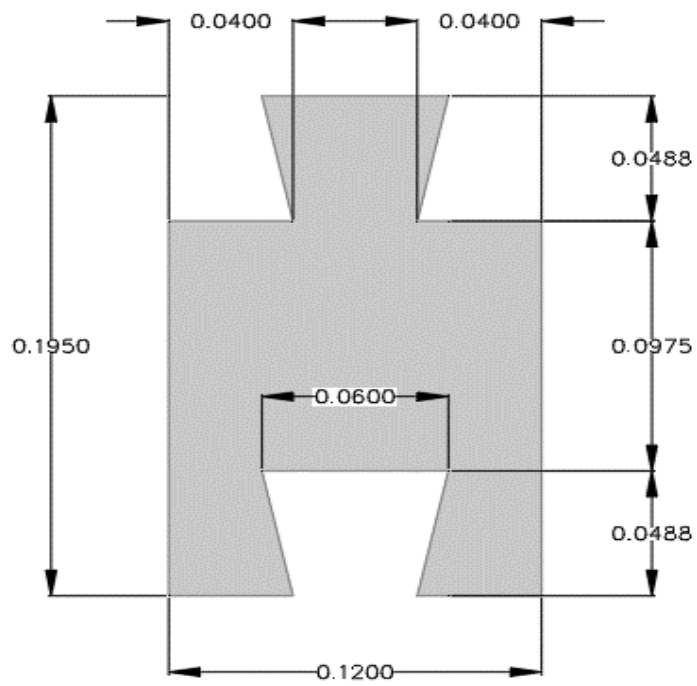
Vista en planta de las dimensiones del bloque tipo II.
